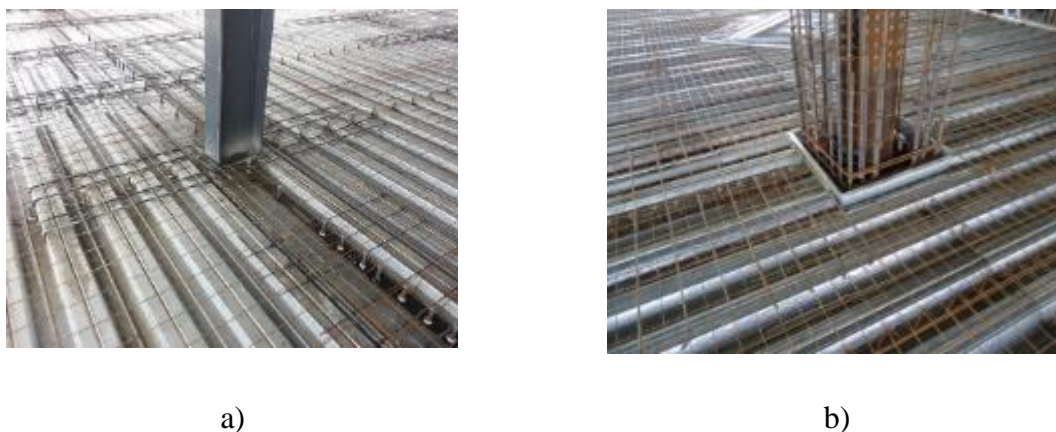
a) Laje mista e pilar metálico b) Laje mista e pilar misto
